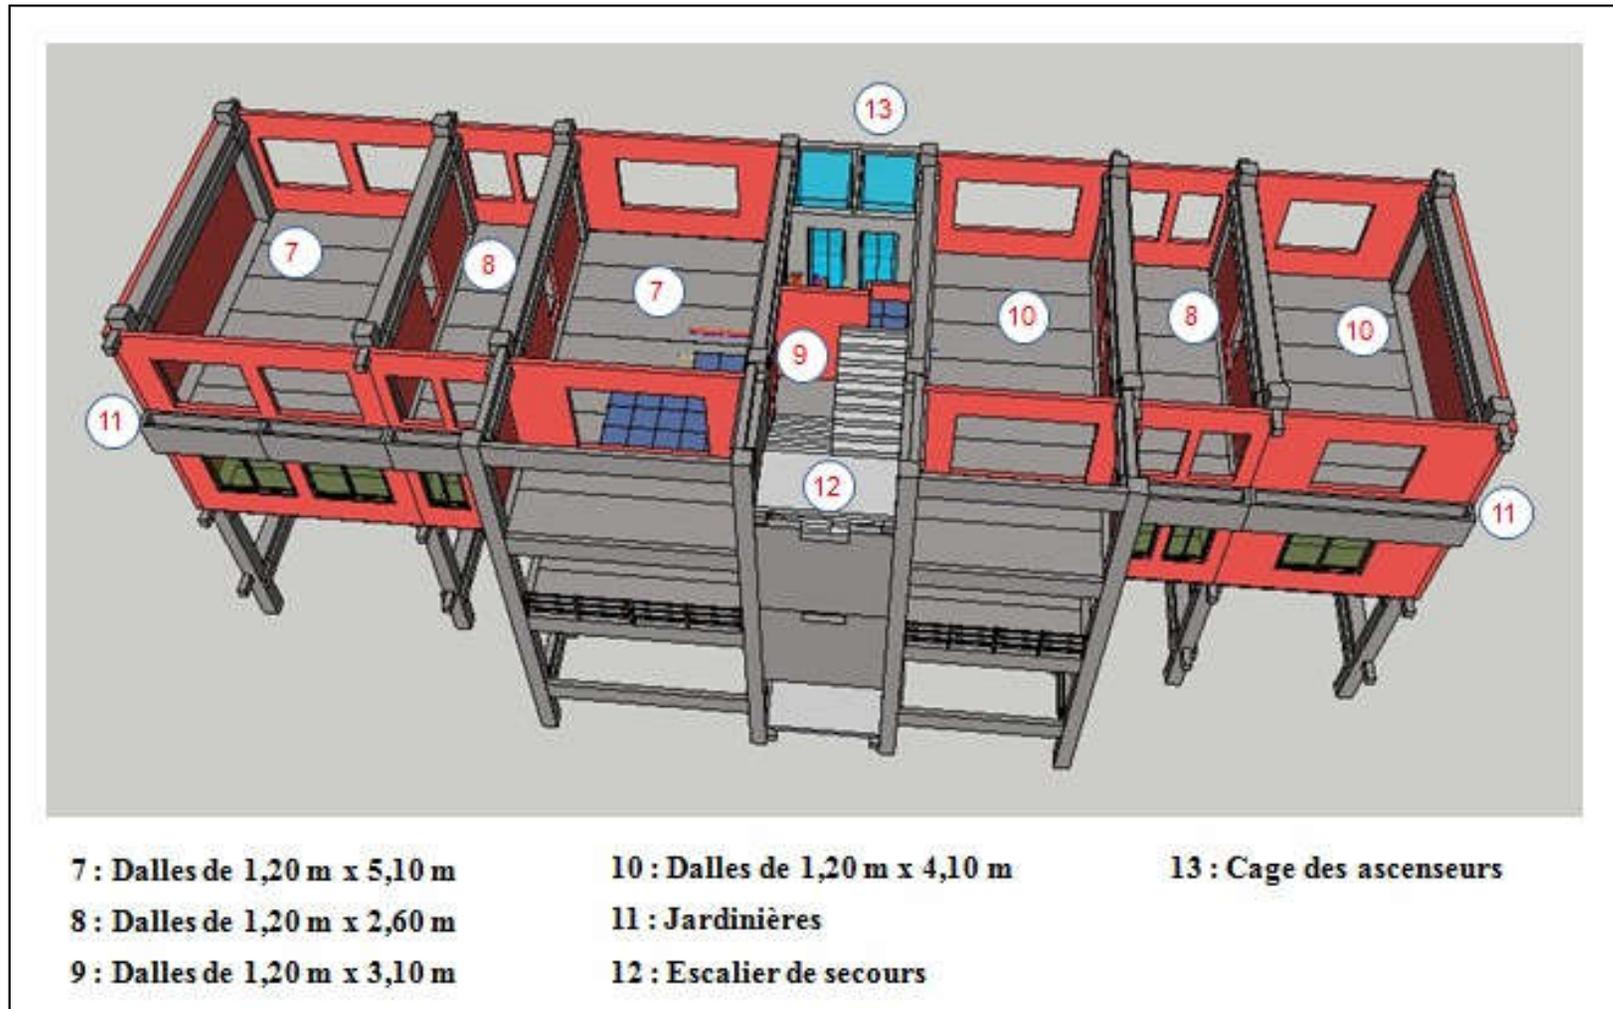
Perspective plongeante sur le bâtiment en poutres et colonnes.
